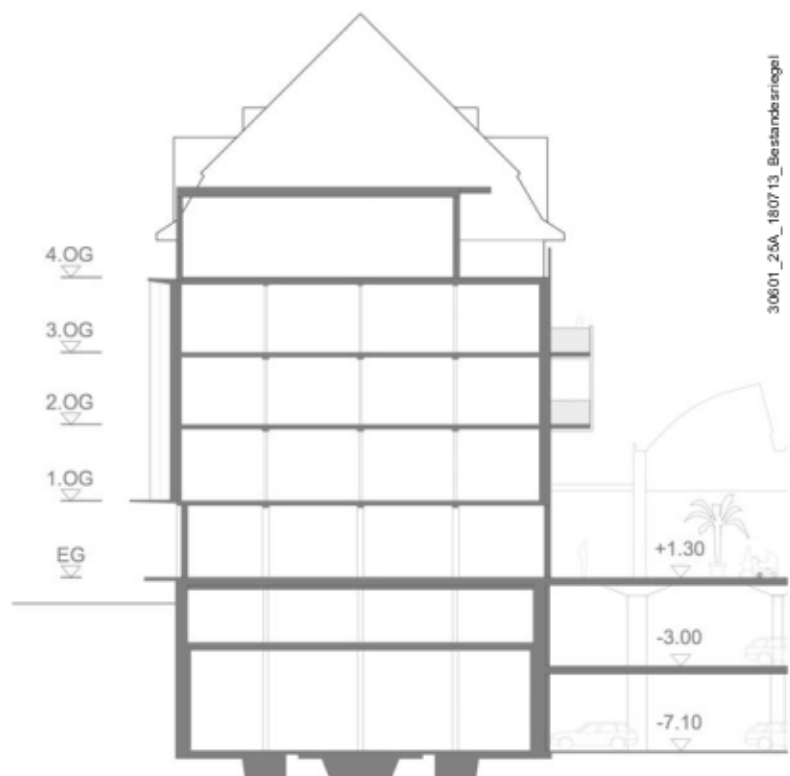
Schnitt durch Bebauung gemäss Richtprojekt im Baubereich A2 mit angehängter Erschliessungsschicht im 2. und 3. OG
